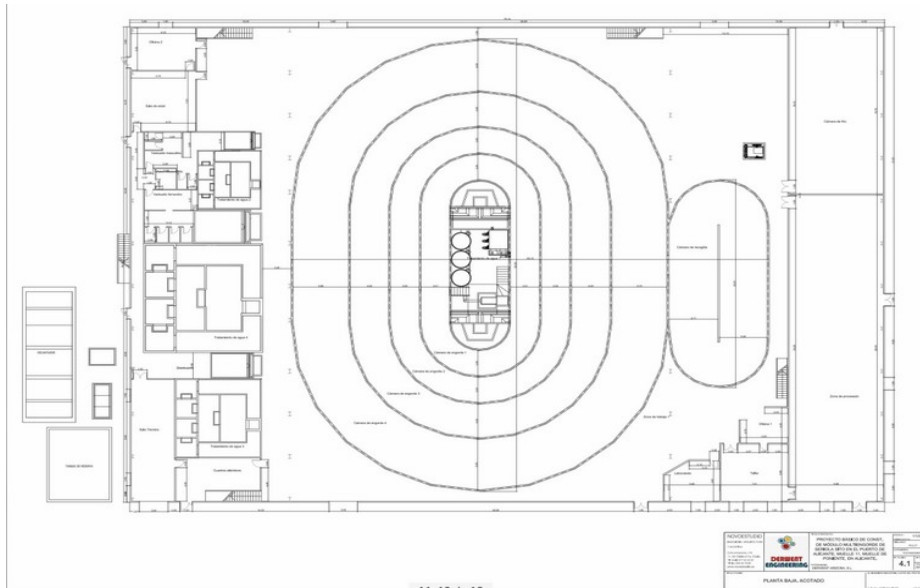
Plano de planta de la granja de engorde proyectada. (Fuente: proyecto técnico)
